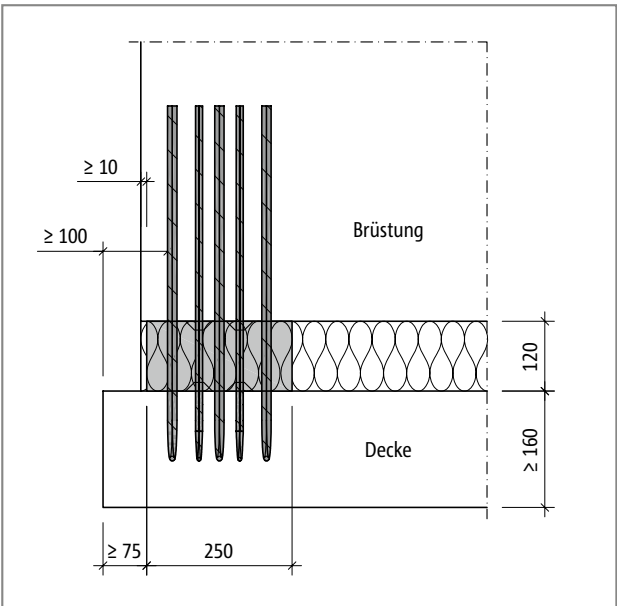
Schöck Isokorb® XT Typ AP vertikale Anordnung: Ansicht Randabstände
